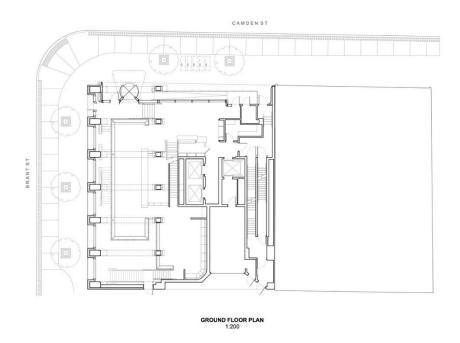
Planta baixa primeiro pavimento Ace Hotel Toronto
